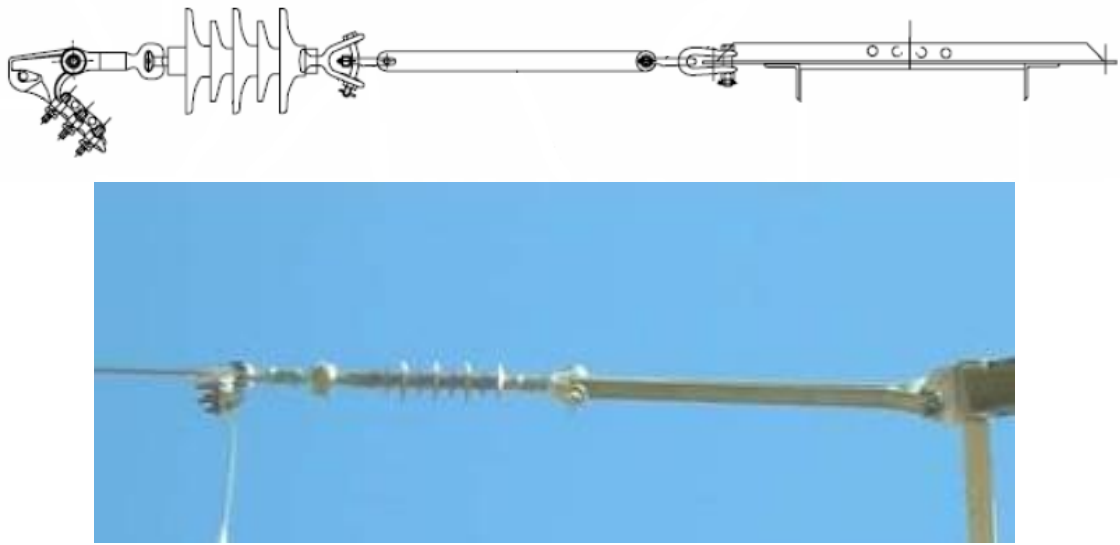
y Foto 14. Alargadera en las cadenas de amarre.
